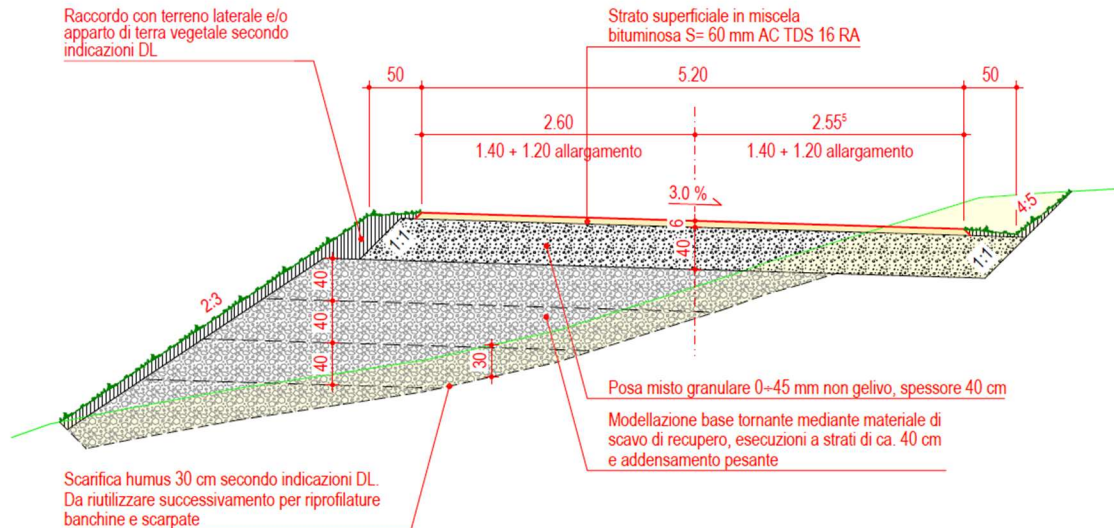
Sezione tipo rilevato al tornante di Quartinasc
